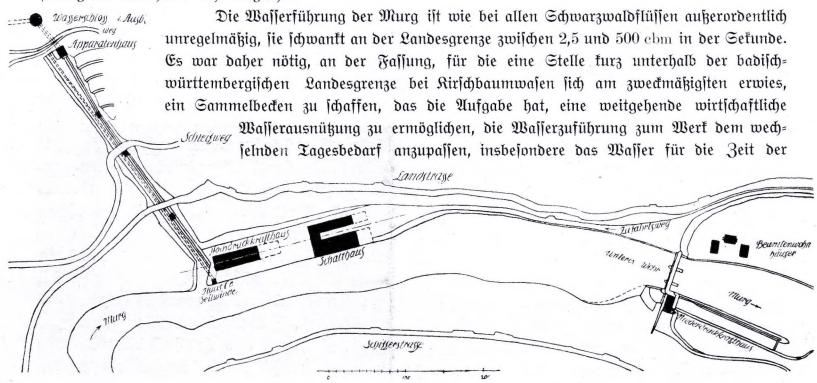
Lageplan des Murgwerkes bei Forbach.
